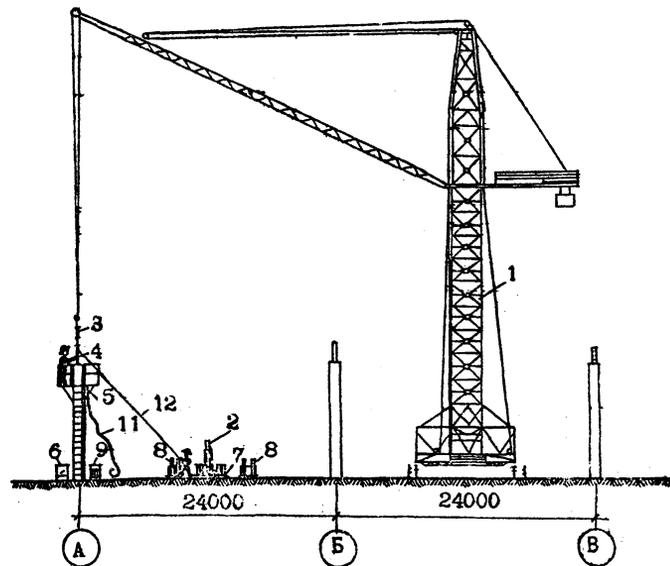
Схема организации рабочего места при монтаже подстропильных ферм.
